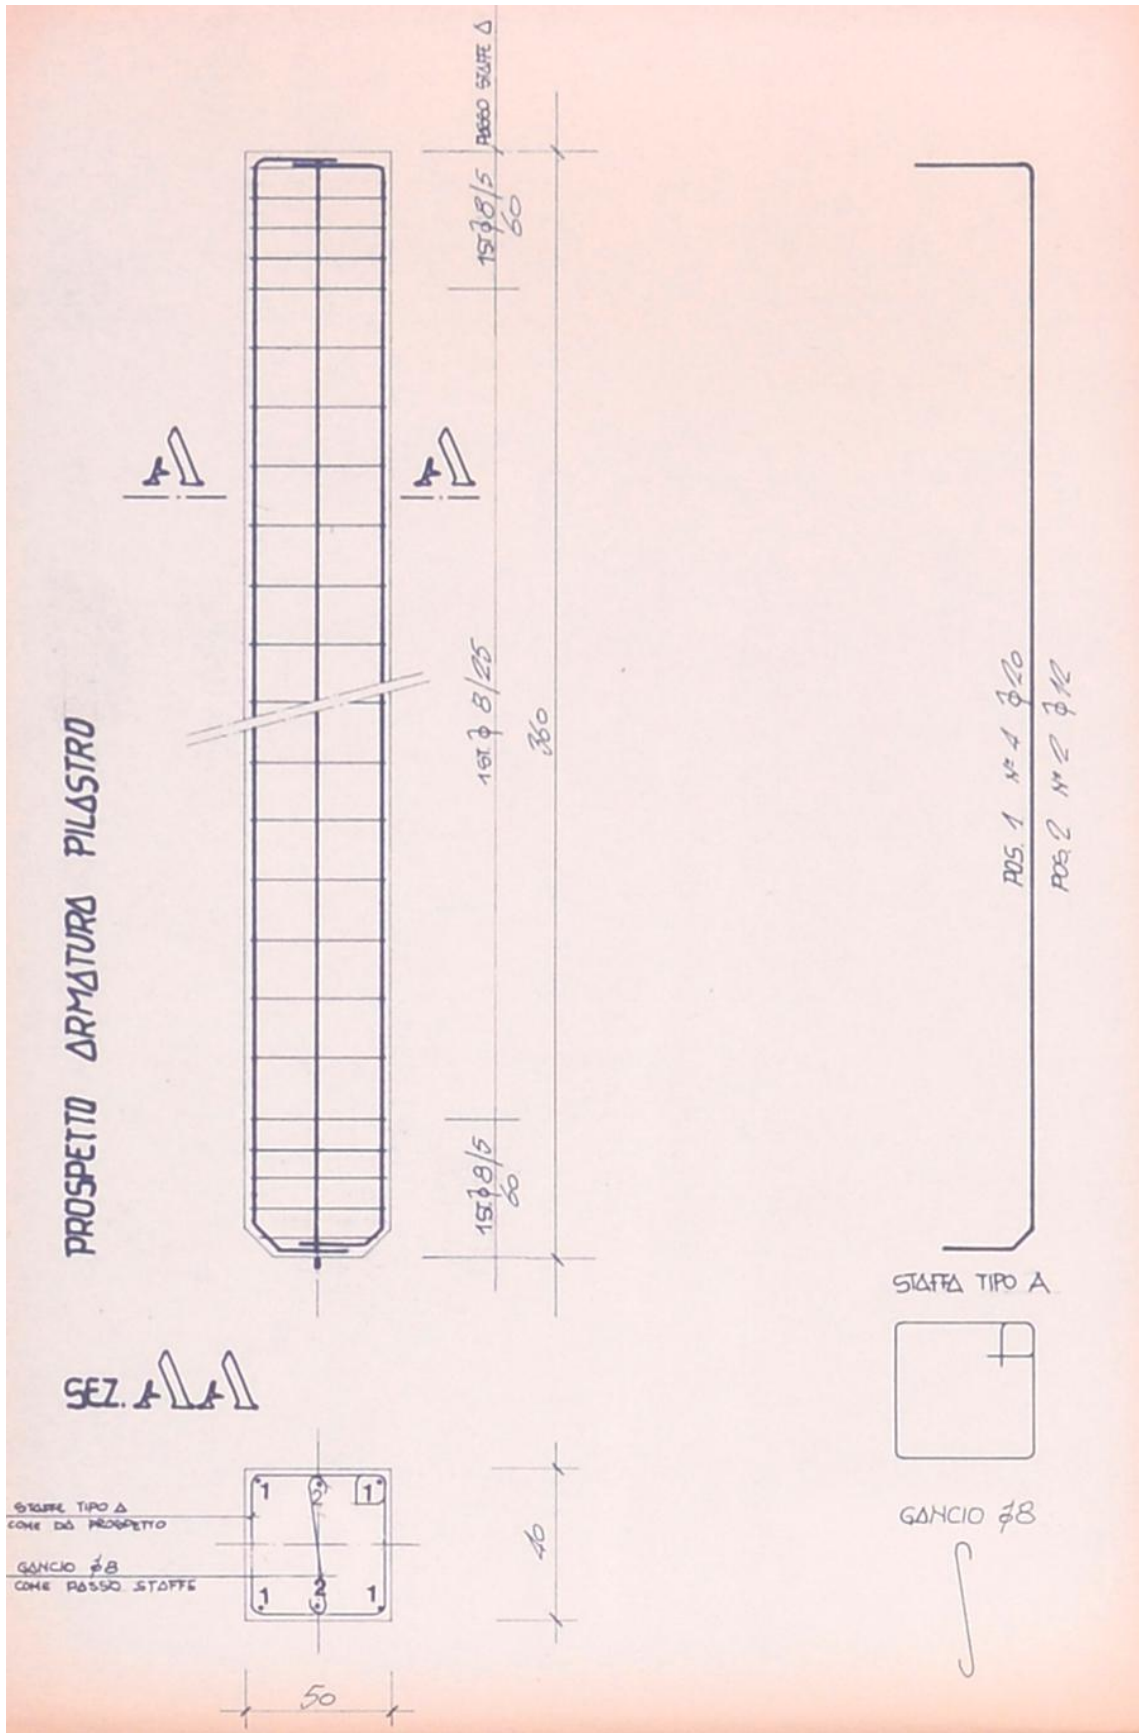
Particolare di A.1990.cap.us.T21 - Armatura e abaco pilastri tipo B-B1
